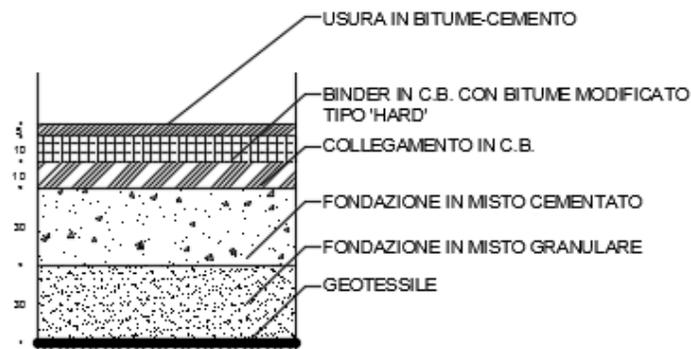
Pacchetto di Pavimentazione Viabilità e Aree di Passaggio / Sosta Automezzi
